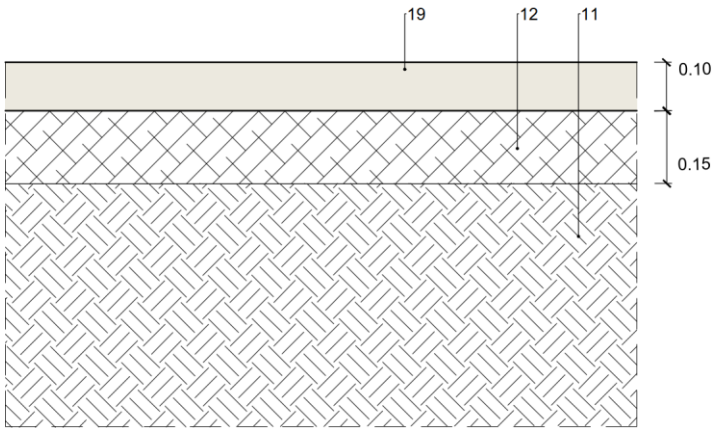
Sección tipo viales con pavimentos de terrizo
